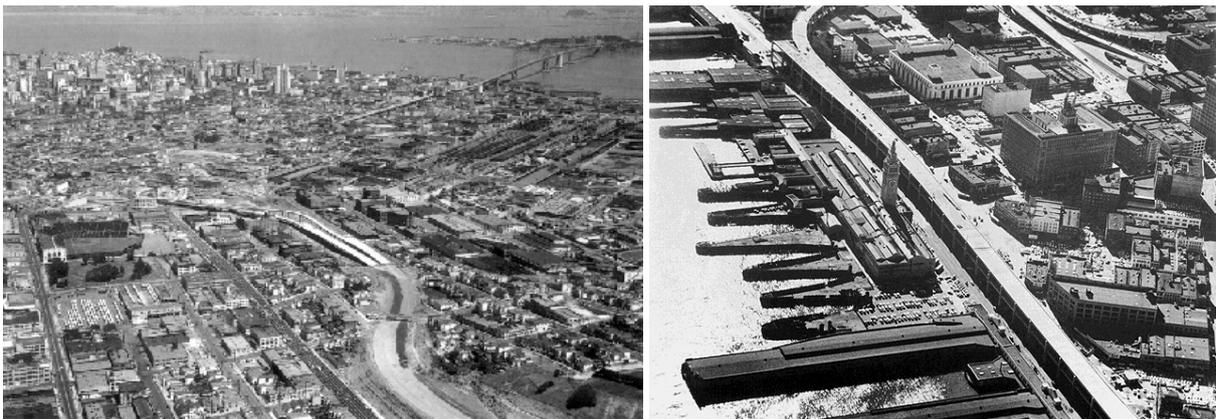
Auto-estrada James Lick Freeway em construção em 1953 – a primeira de San Francisco. Foto: Ed Brady. Fonte: foundsf.org. b) A Embarcadero Freeway em 1958 (entretanto removida).
